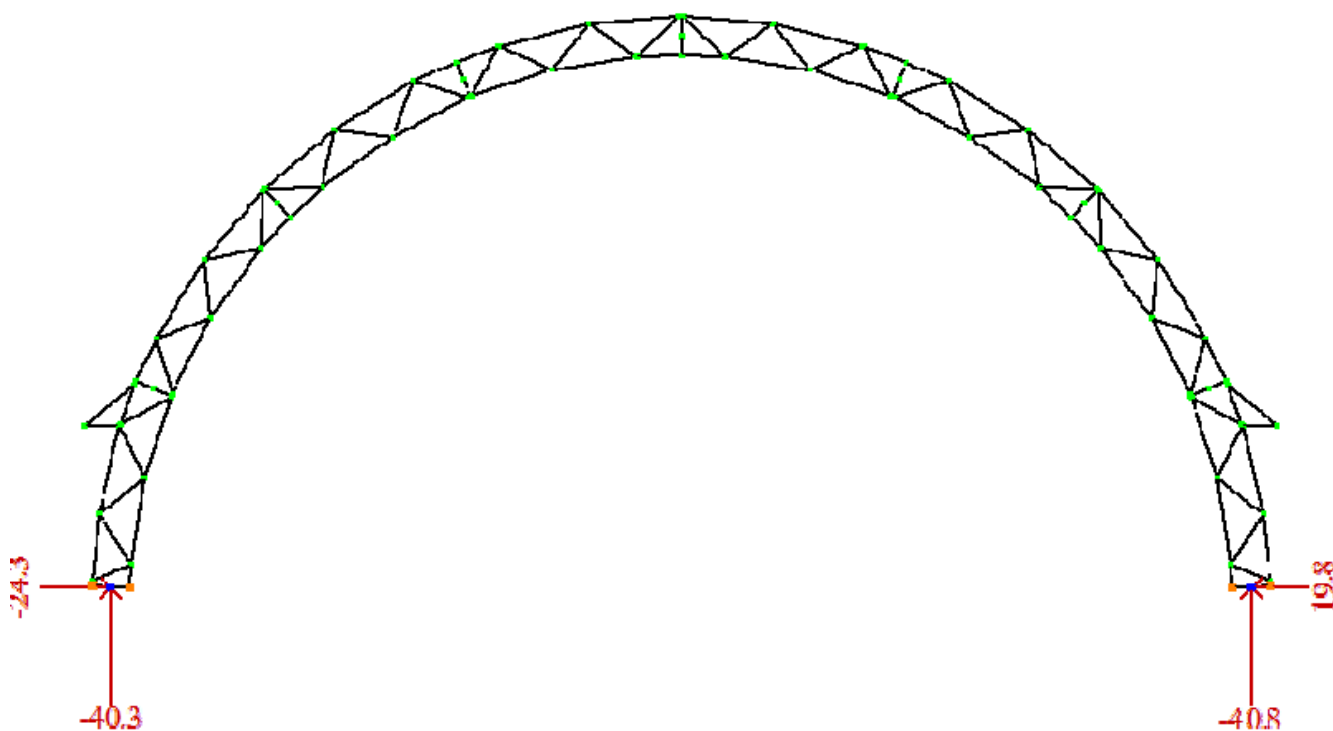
Схема навантаження на фундаменти від рядових арок та розрахункової комбінації зусиль.
